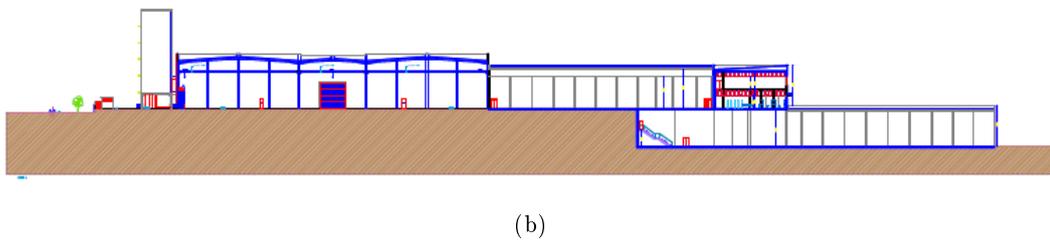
Planta da instalação fabril, com cortes de perfil
